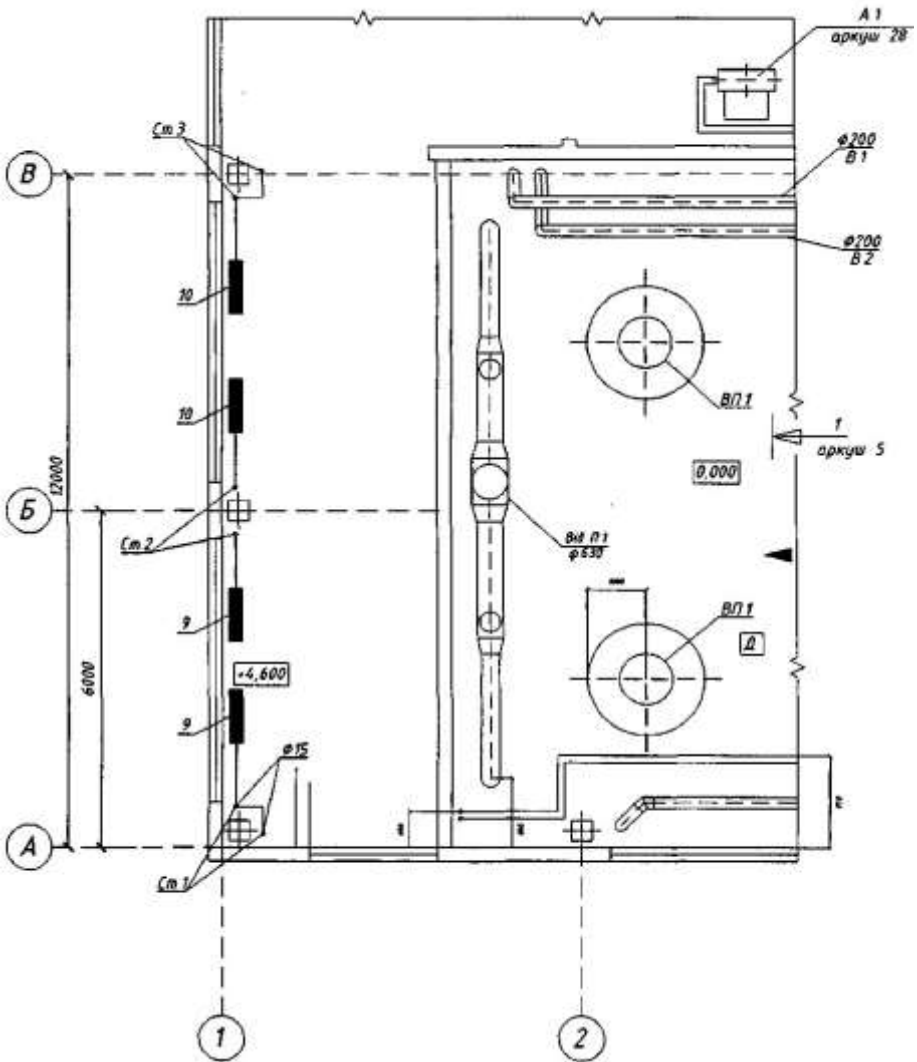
Приклад оформлення плану системи опалення та вентиляції будівлі. План 3-3 (3-3 вказує на позначку площини горизонтального розрізу)
